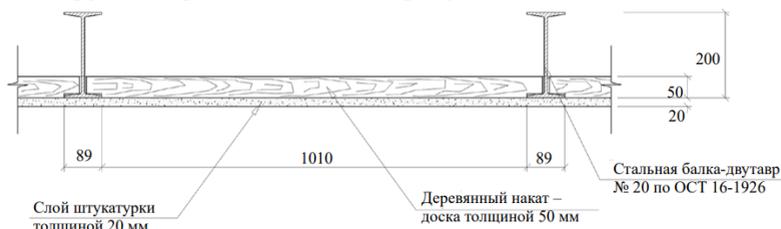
Состав междуэтажного перекрытия надземного этажа жилого дома(после демонтажа конструкций полов)
